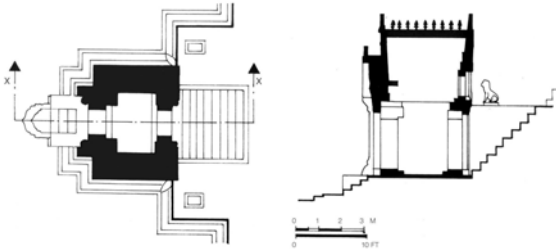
Grundriss/Schnitt Adikulae Bakong/Rolous
